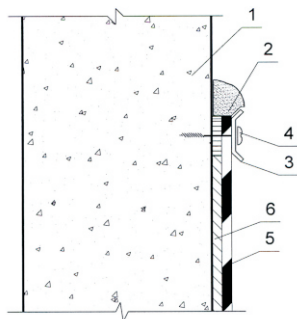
Примыкание кровли к стене (парапету) высотой более 450 мм
